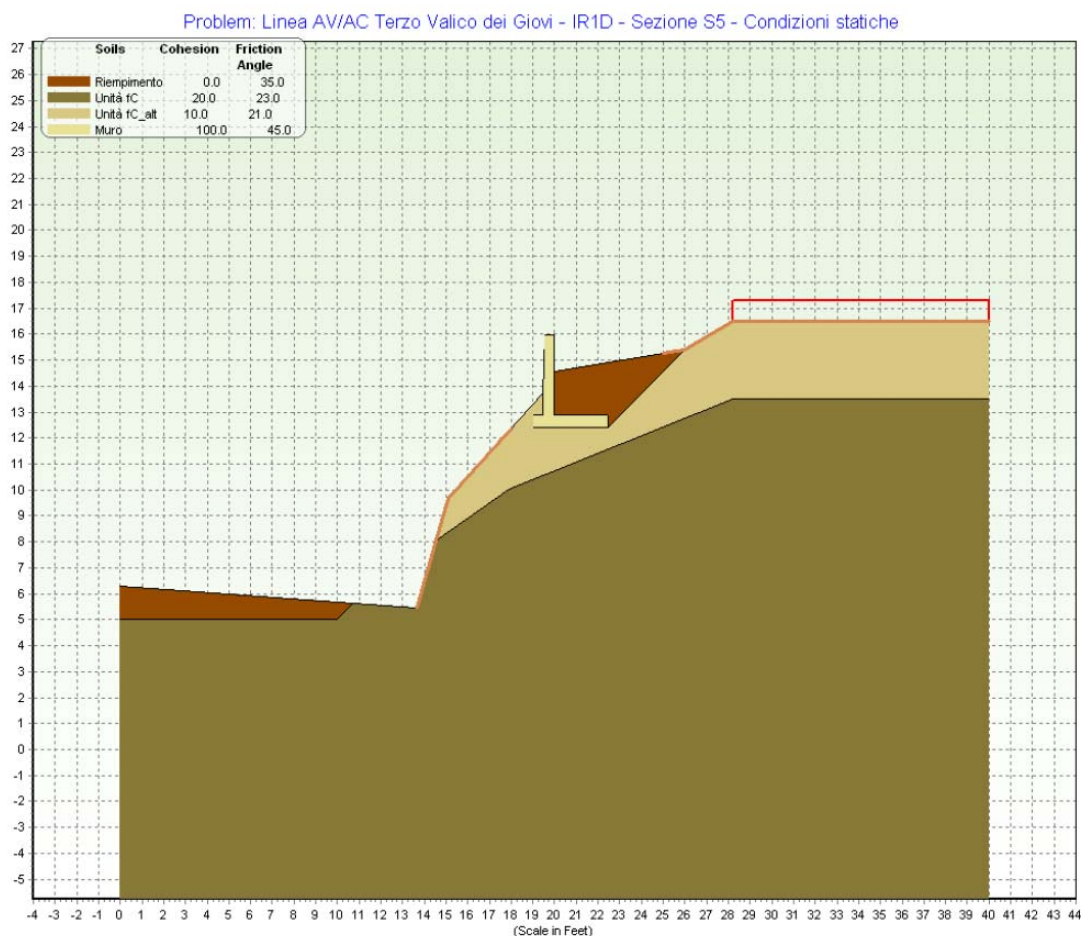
IR1D – Geometria della sezione attuale in trincea pk 0+108.42
